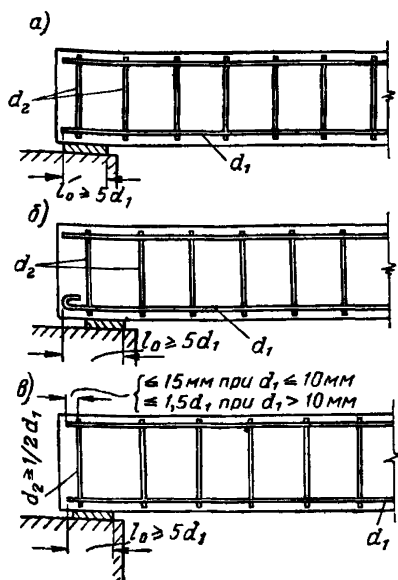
Анкеровка сварных сеток на свободных опорах плит
